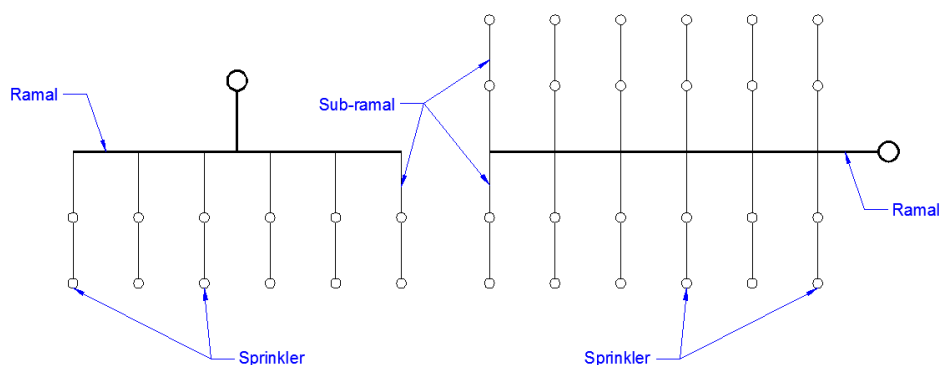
Implantação de elementos de sistemas de sprinklers (adaptado de [18])
